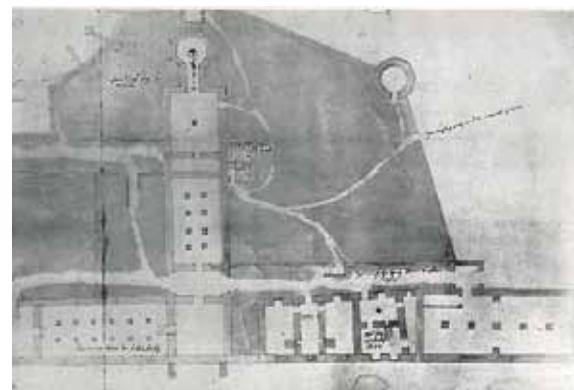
Grundriss des Karners im Untergeschoss unter dem Dormitorium von Stift Zwettl. Klosterplan 1644. Buberl 1940.
